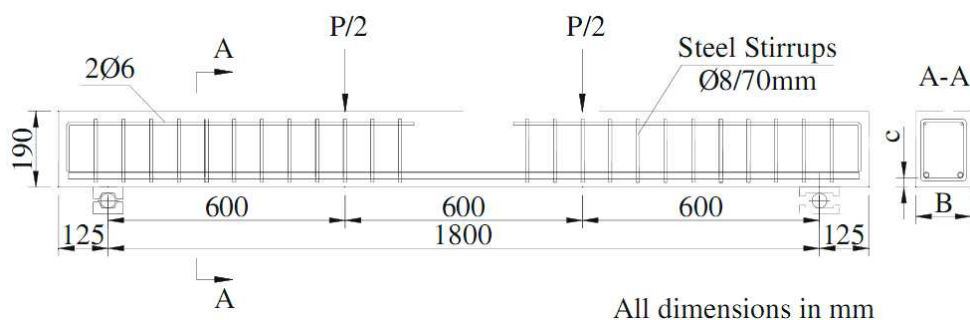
Dimensões e pormenorização das vigas ensaiadas por Barris et al.[23]
